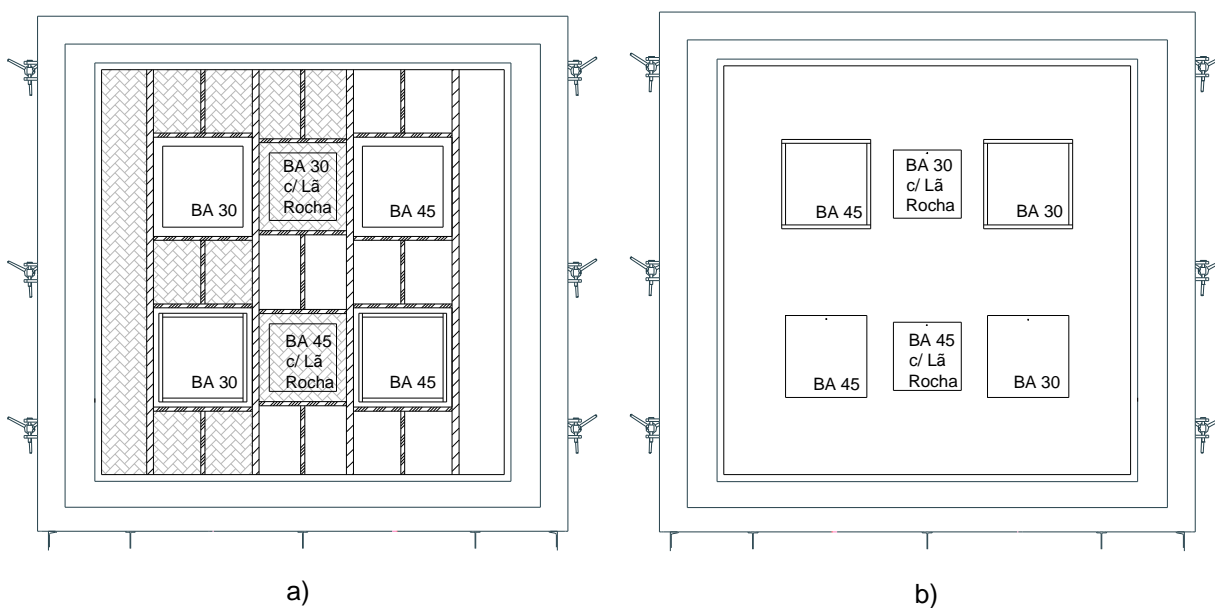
Desenho da amostra ensaiada. a) Face não exposta b) Face exposta. [19]
